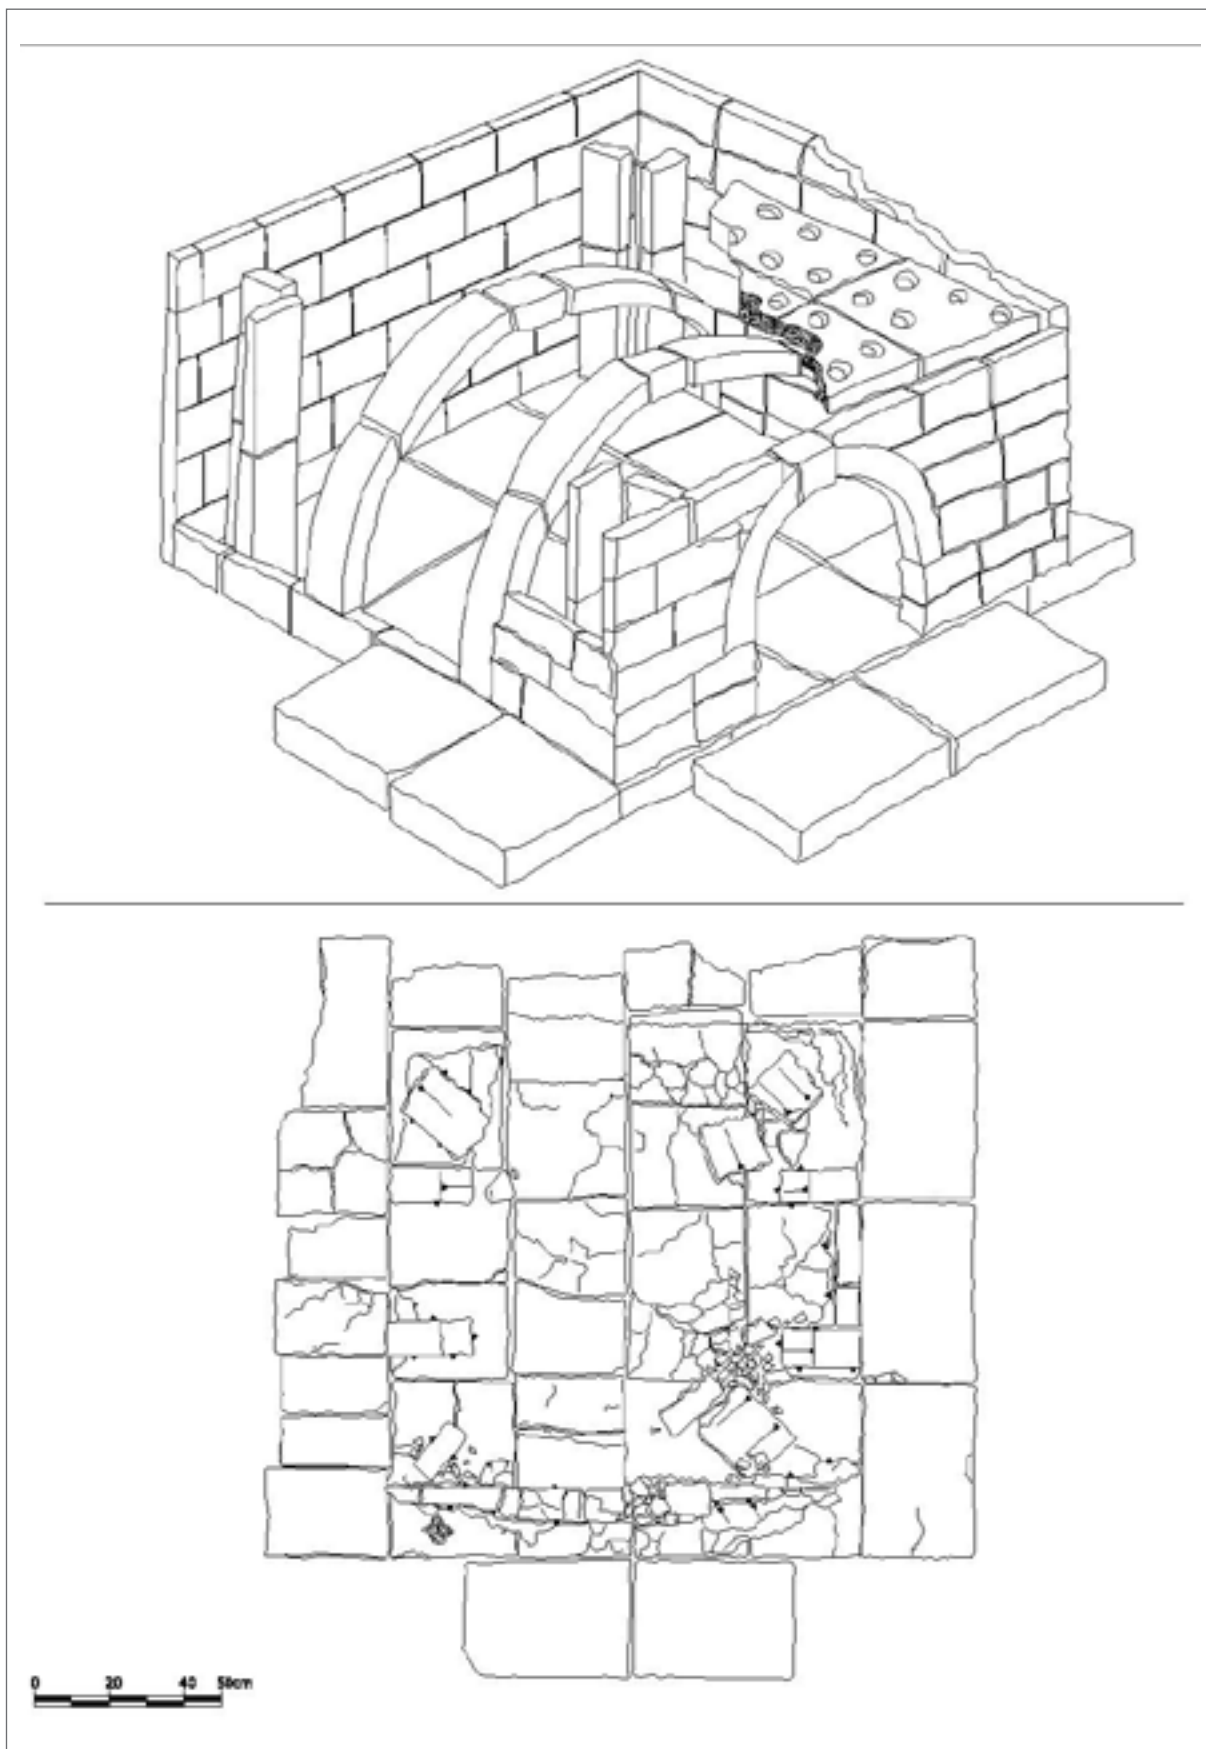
Assonometria prospettica ricostruttiva della fornace; planimetria
